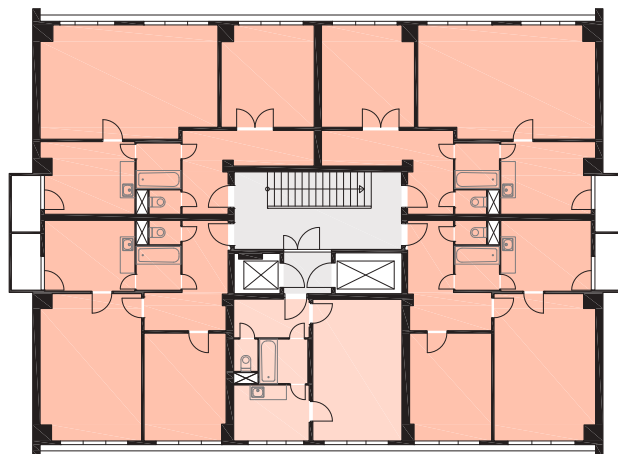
Konstrukční soustava V-OS (Zdroj: panelaky.info)
